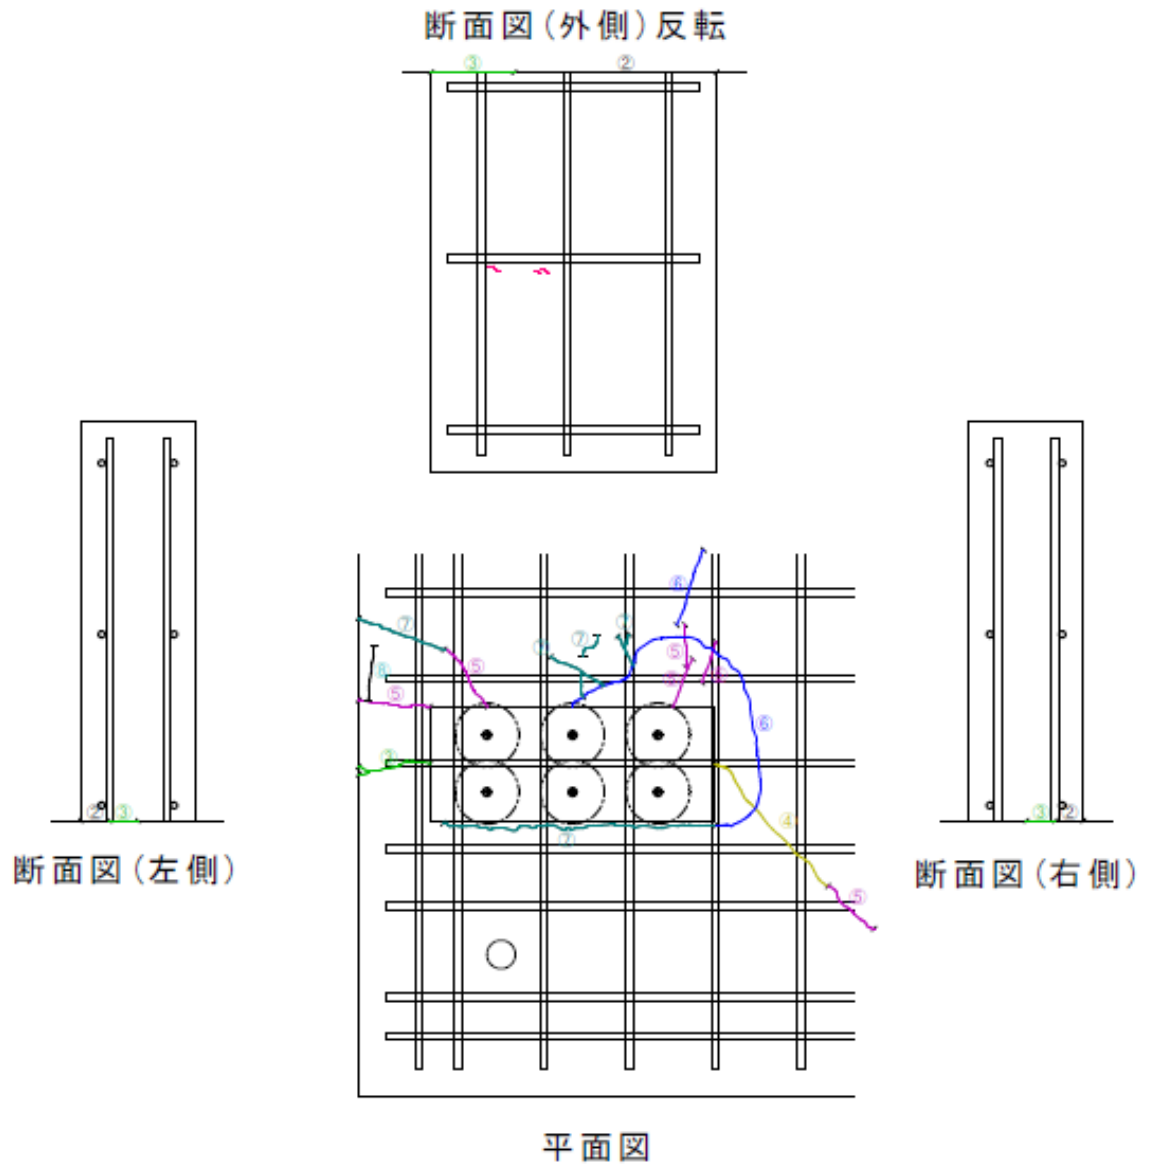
ひび割れ図および最終破壊状況写真 (No.6L)
